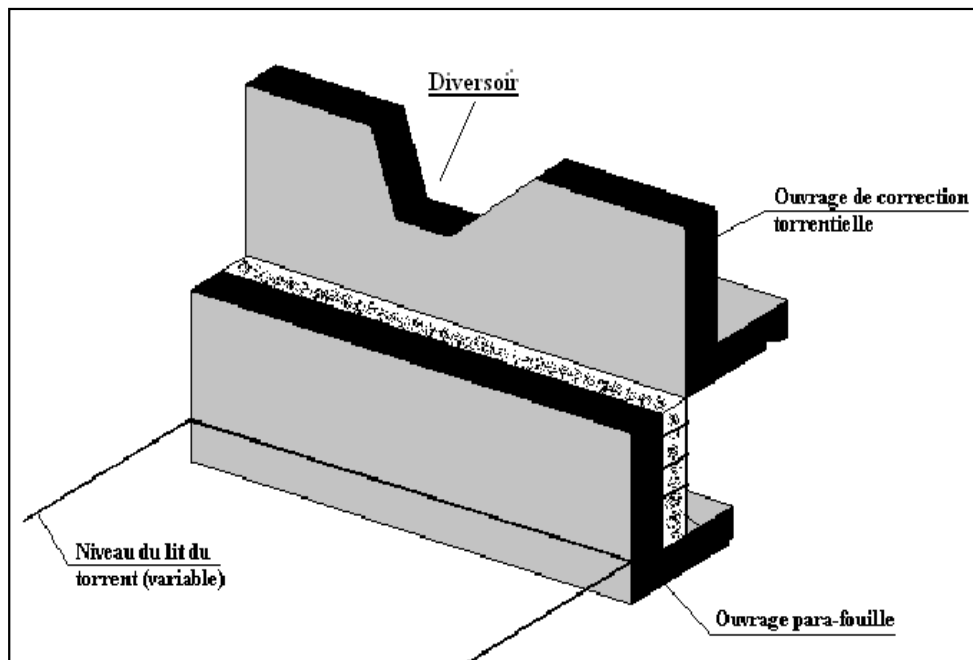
Schéma d'un Ouvrage type de correction torrentielle
